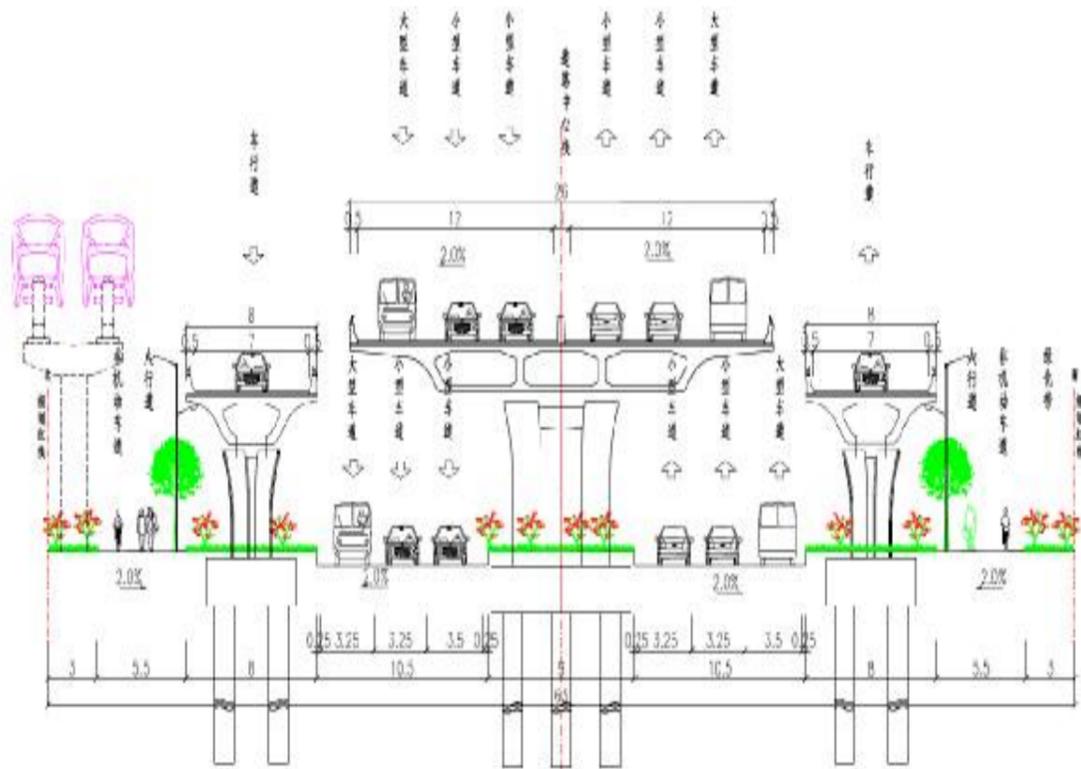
光华路-厦岭路段横断面图（尺寸单位：m）
